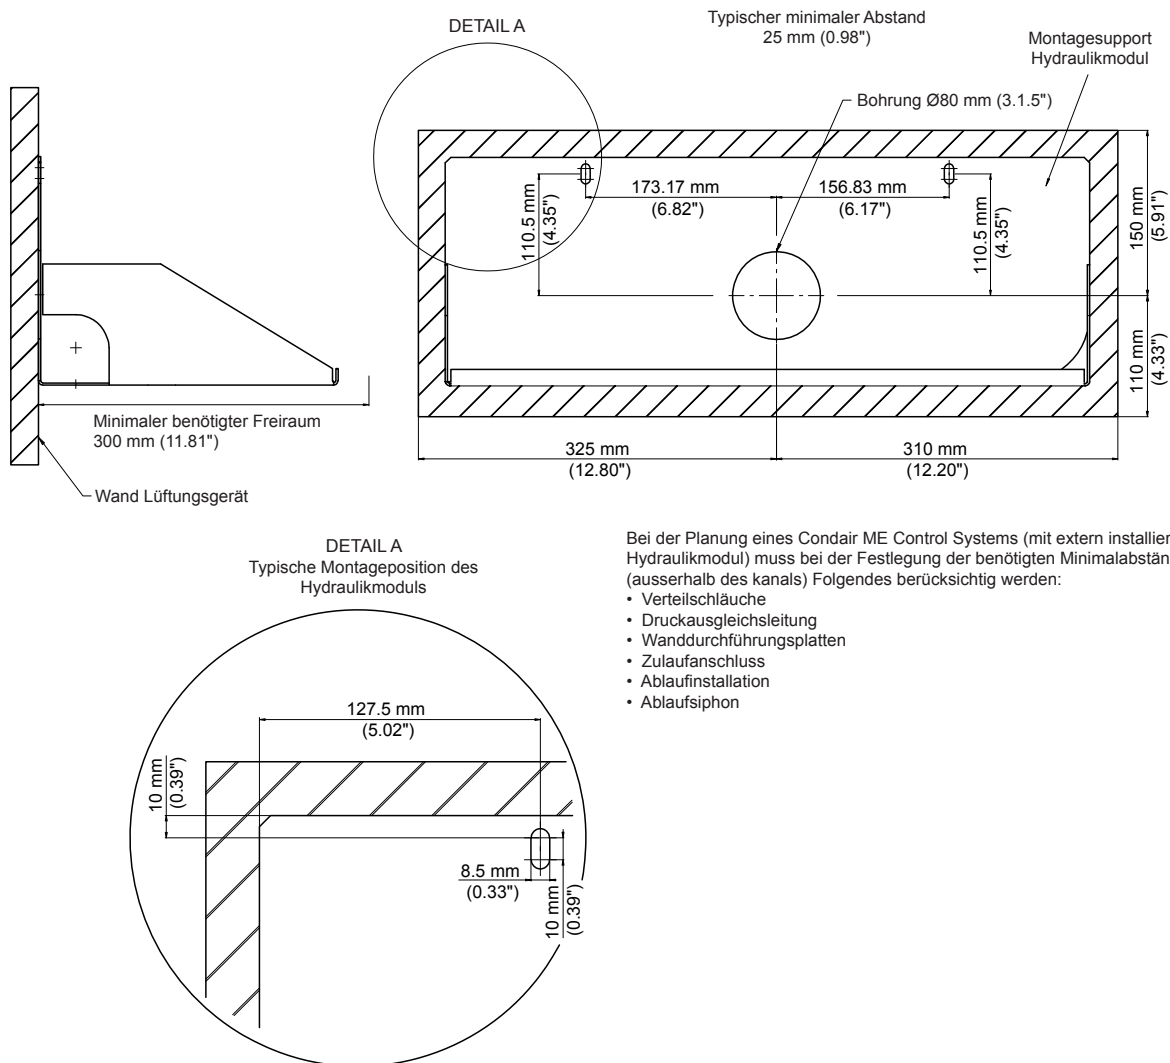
Masse/Minimalabstände Hydraulikmodul Condair ME Control (Aussenmontage)
